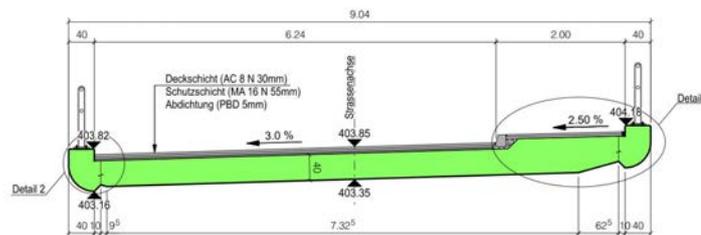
Querschnitt Brücke Emserenstrasse, Ächeli
